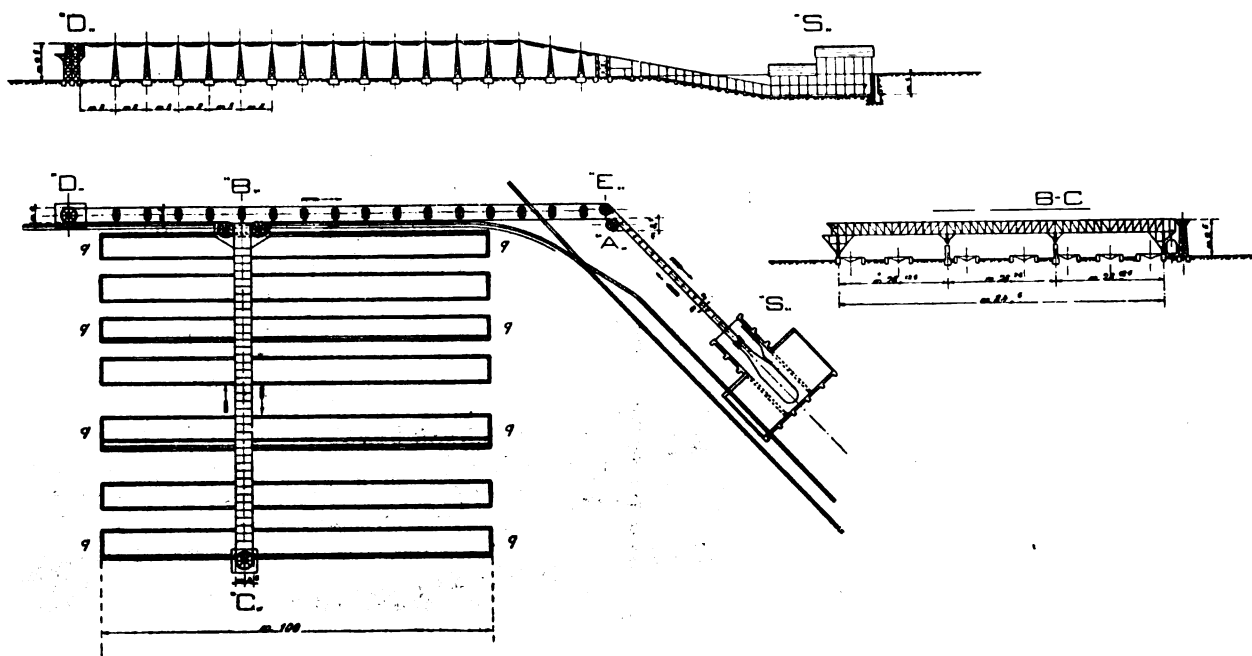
, 17 e 18. — Impianto del Zuccherificio di Avezzano - Disposizione generale.
